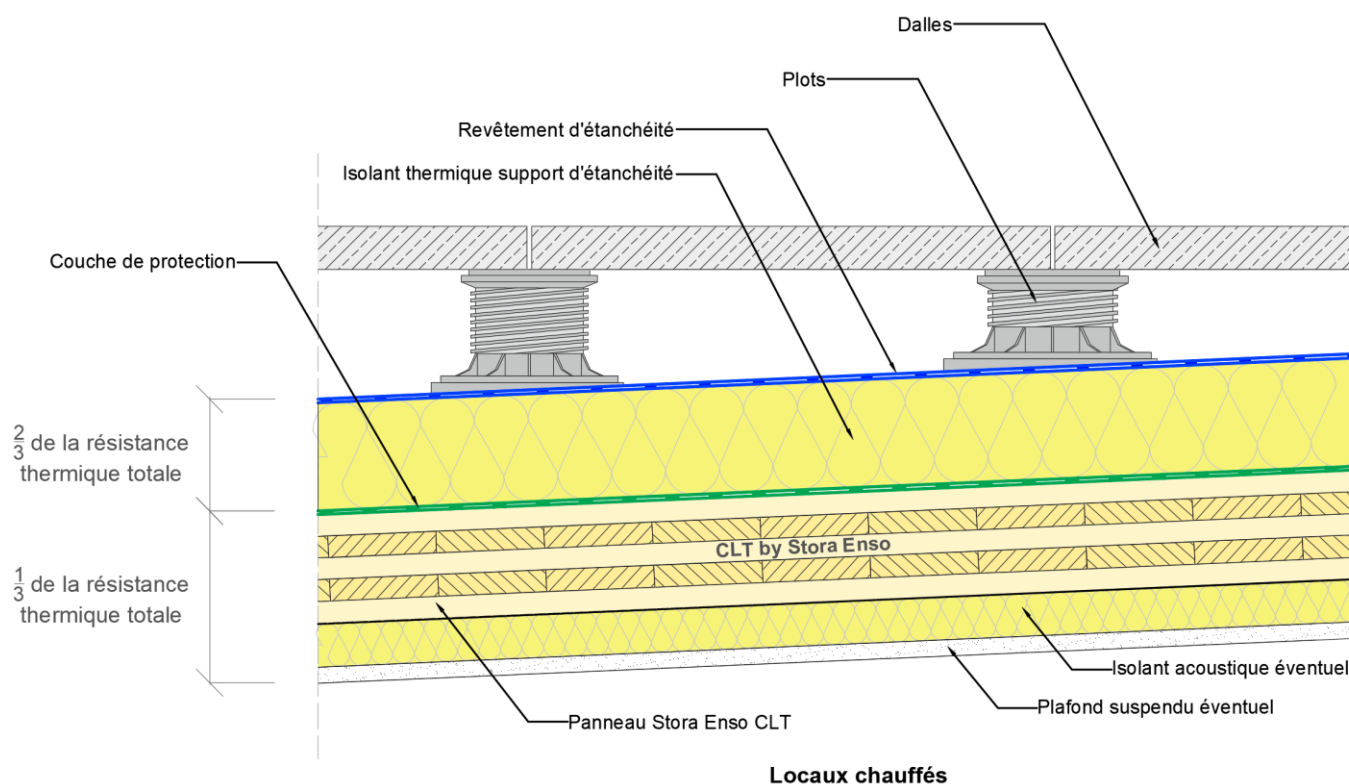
Schéma de principe - Toitures terrasses accessibles aux piétons et au séjour avec protection par dalles sur plots - Isolation support d'étanchéité. (Pente $\leq 5\%$ et $\geq 1,6\%$; $1,8\%$ ou 3%)
